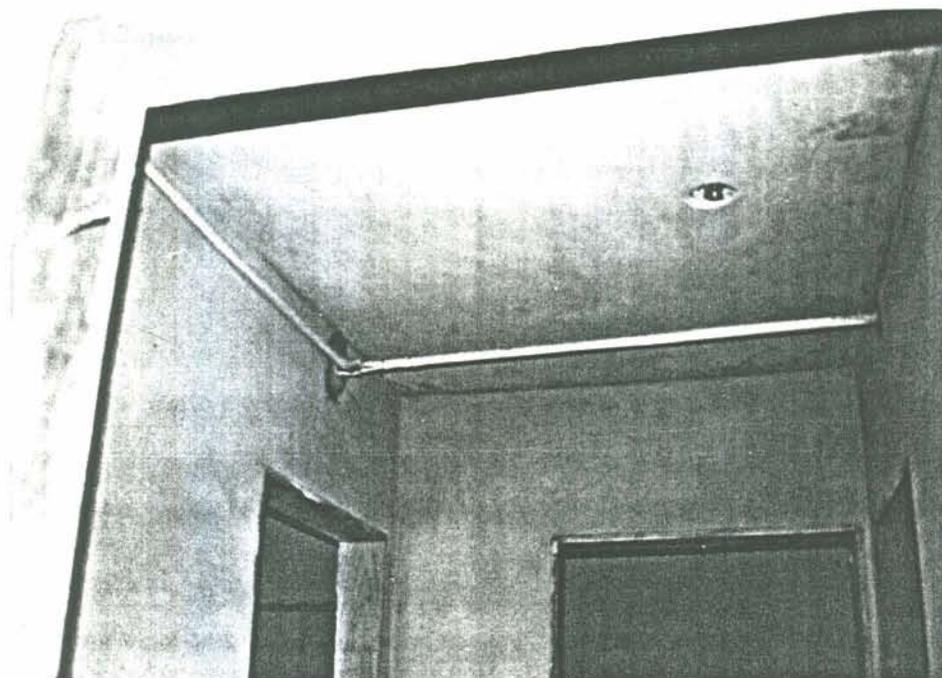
REVESTIMENTO ARGAMASSADO EM FORRO QUE RECEBERÁ REBAIXAMENTO (OBRA A).
